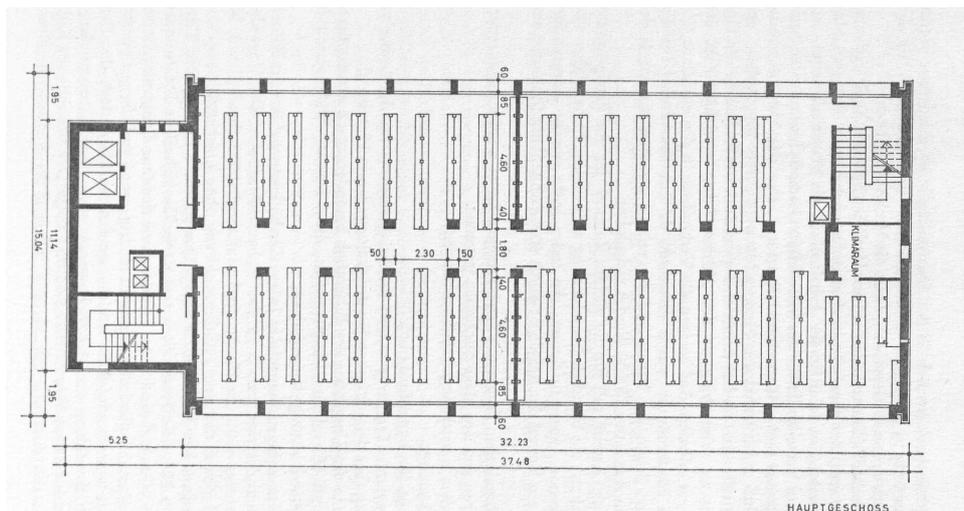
Grundriß eines Magazinstockwerks im Bücherturm
